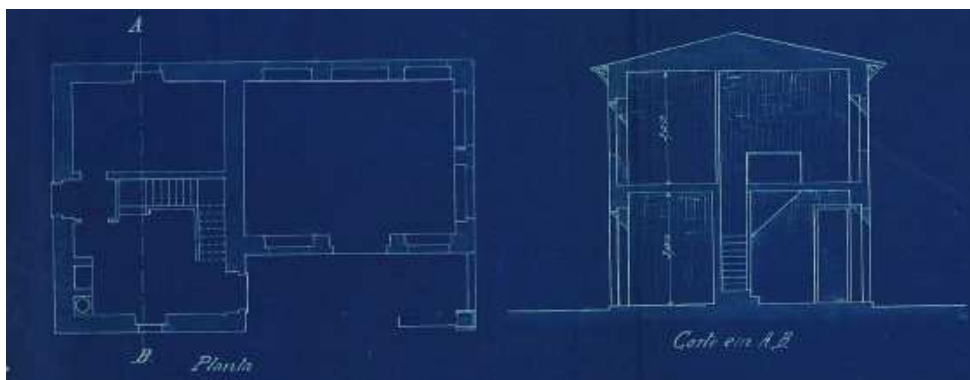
Planta e corte da casa de habitação, Fonte: Arquivo CML.
